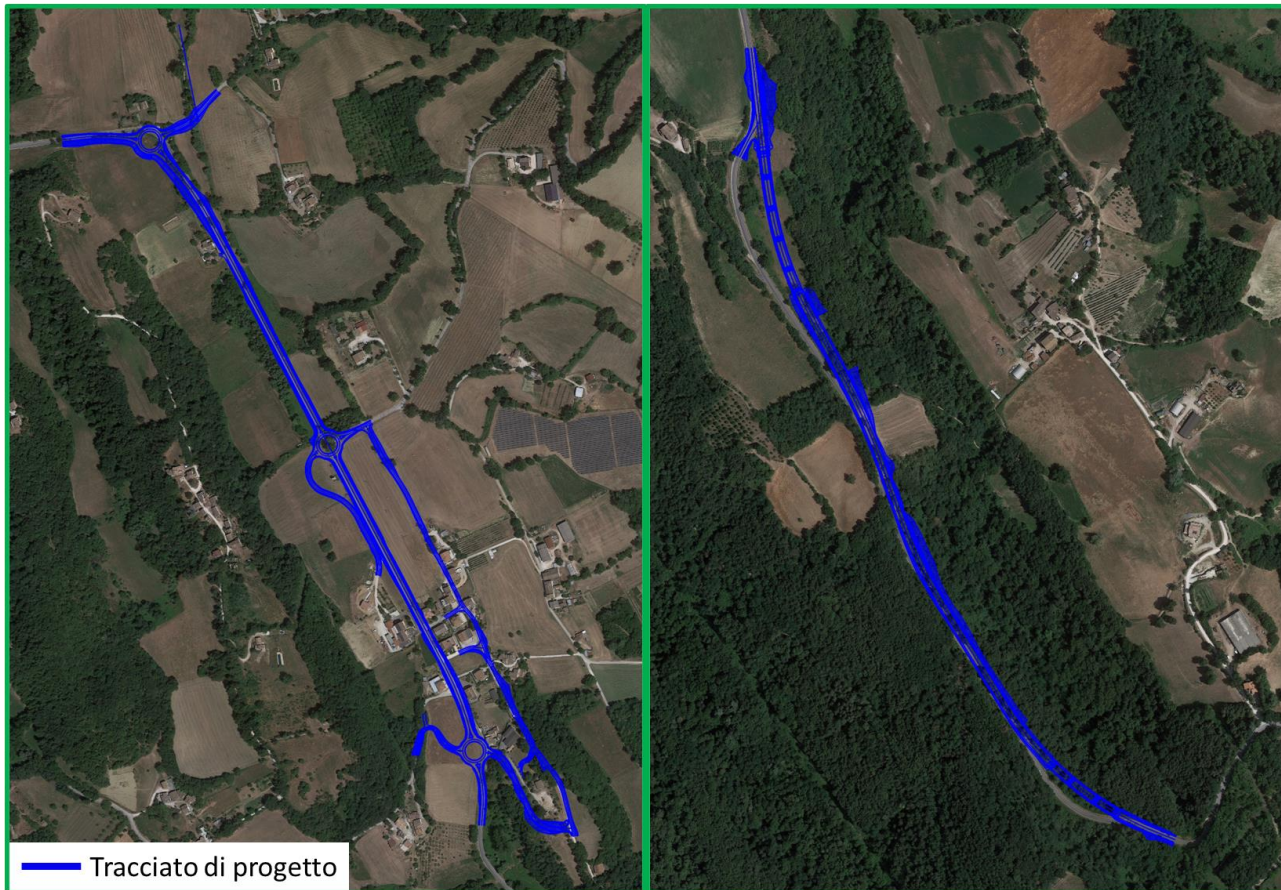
CONFRONTO TRA STATO ATTUALE E PLANIMETRIA DI PROGETTO
